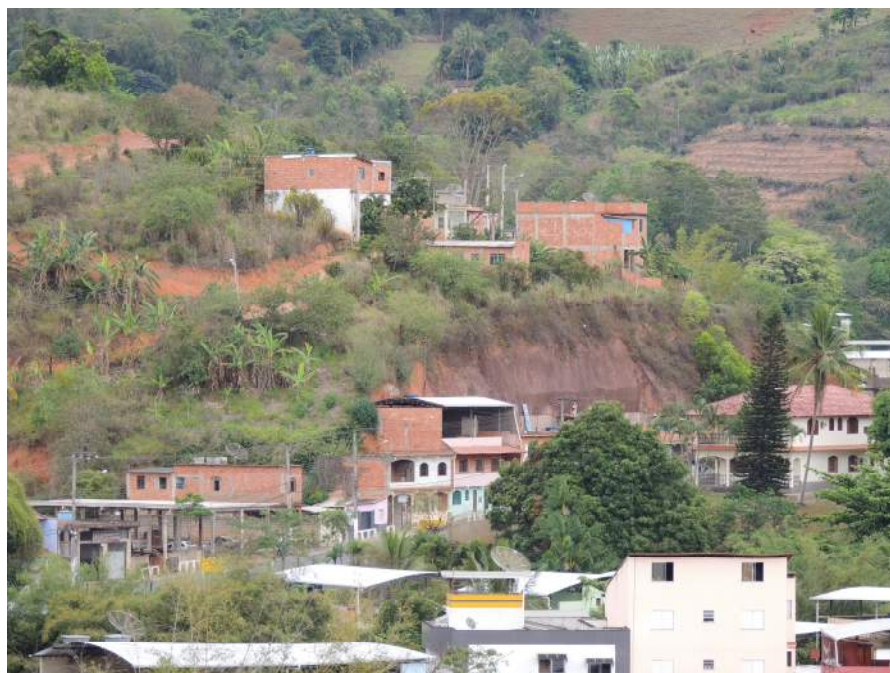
Vista frontal do setor de risco com detalhe para as dimensões do talude de corte.
